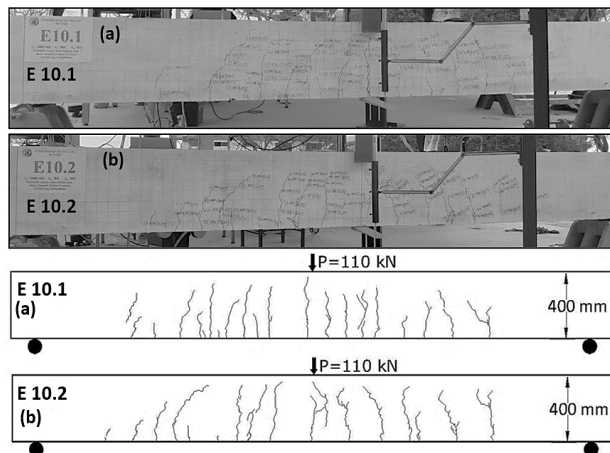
Fisuración para la carga de fallo por fluencia: (a) Especímen E 10.1 (b) Especímen E 10.2.
